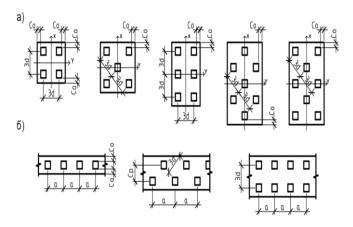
Схемы расположения свай в ростверках а) свайные кусты; б) свайные ленты
